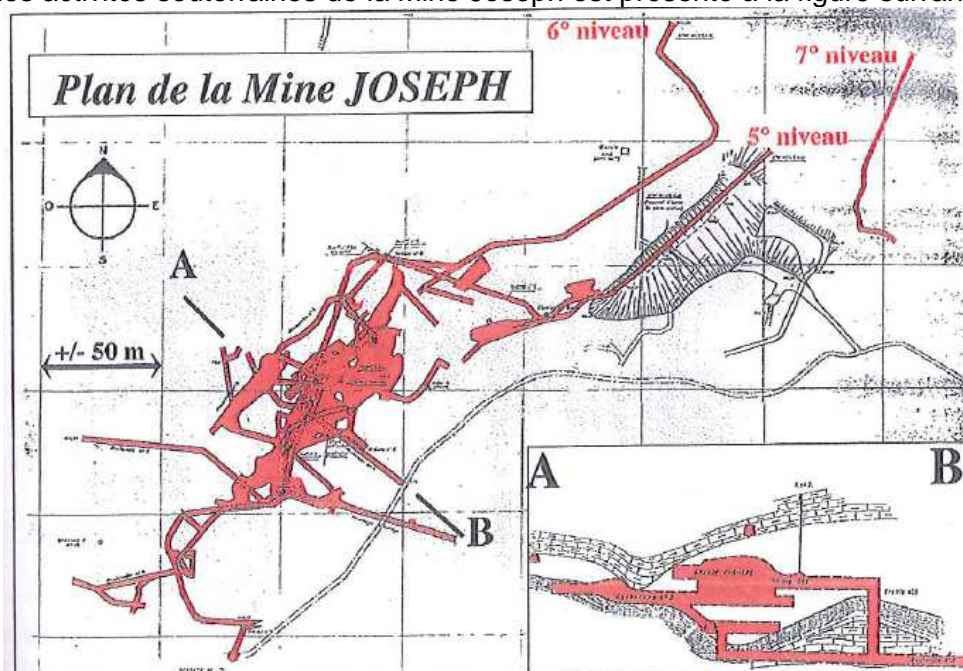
Plan masse des niveaux souterrains de la Mine Joseph
